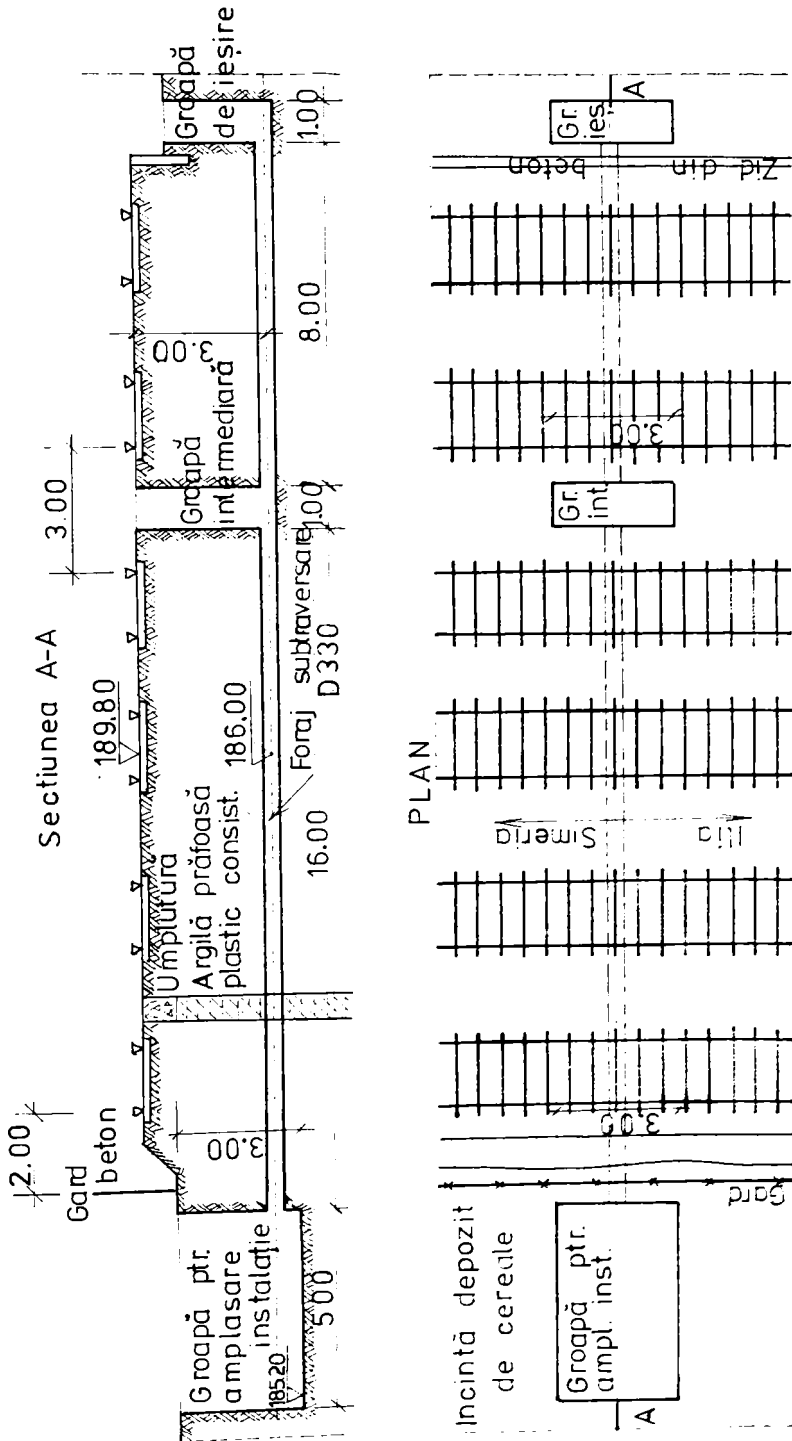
Secțiune și plan pentru subtraversarea căii ferate la Deva
